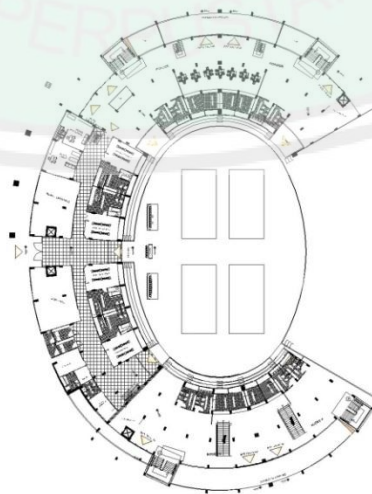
Denah lantai 2 Kantor dan Asrama
